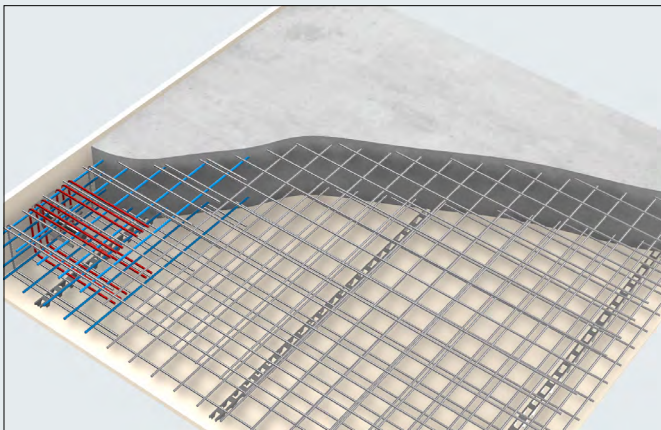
Zusätzliche Bewehrung verlegen und nach Bewehrungskontrolle Platte betonieren.
